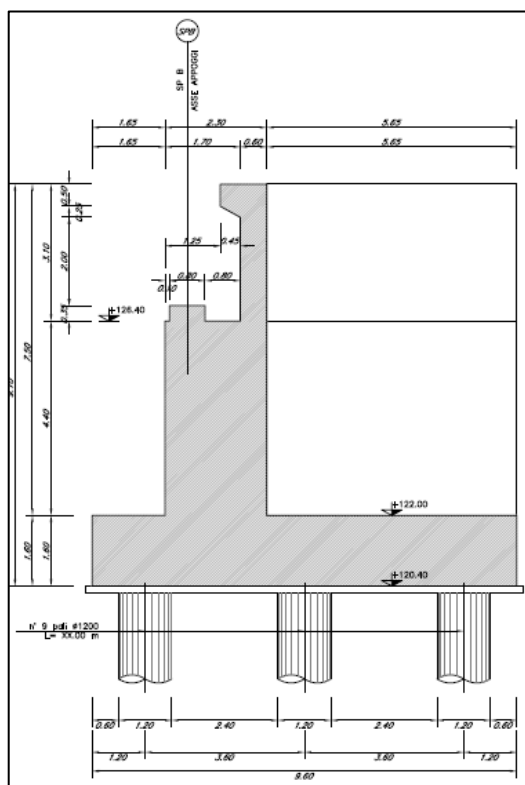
Carpenteria spalle: sezione trasversale – Progetto Esecutivo di Modifica (Fonte: “Relazione generale” - RS39-10-V-ZZ-RG-NWV800-001\_A)
